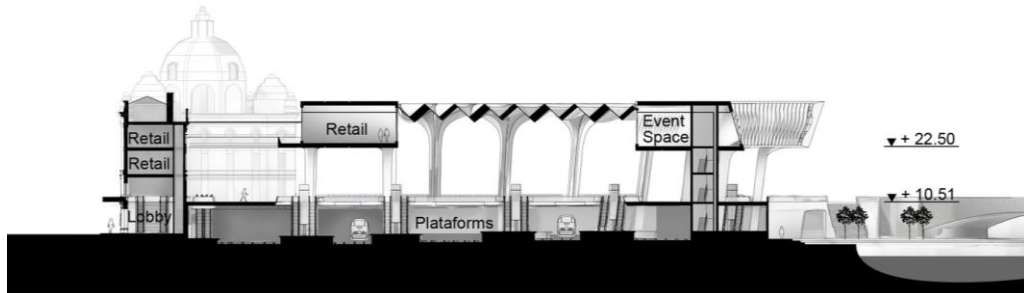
24 Potongan Membujur Kantor dan Retail
